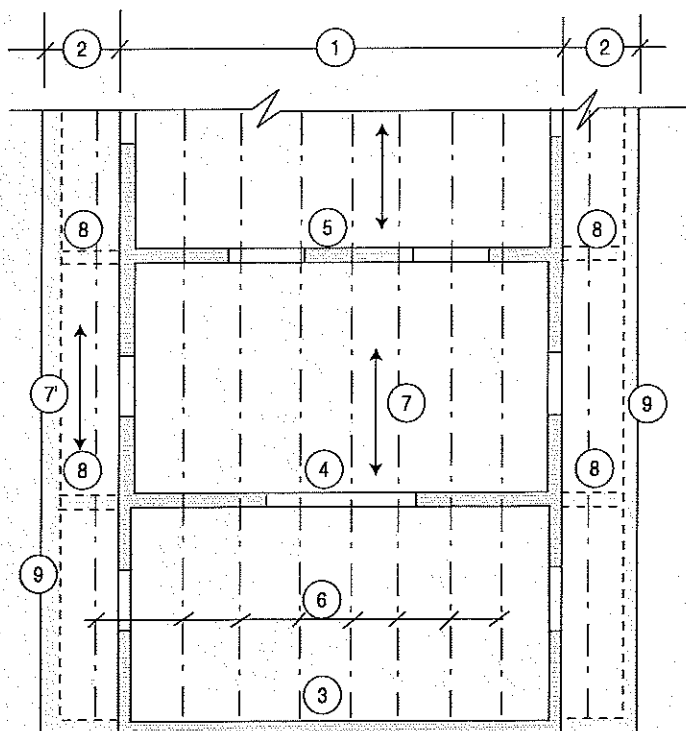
Plan du plancher haut de rez-de-chaussée.
